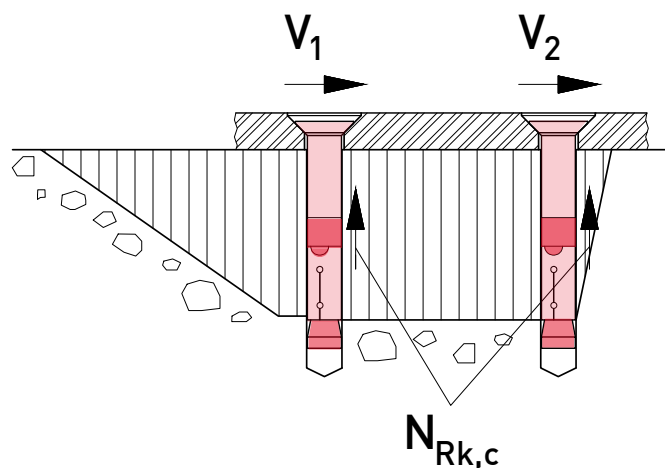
Betonausbruch auf der lastabgewandten Seite unter Einfluss einer Querbelastung
